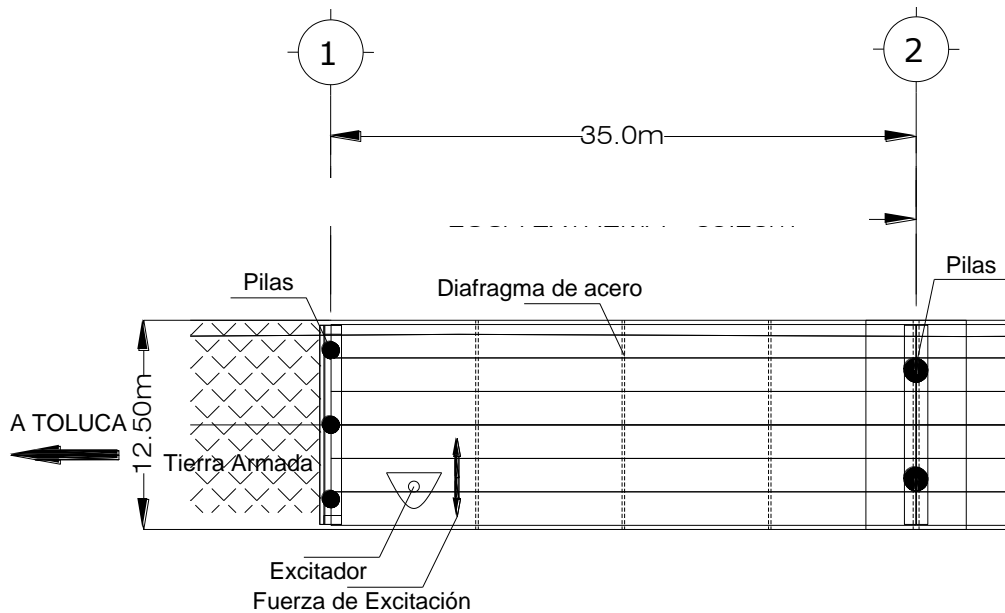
Vista en planta de la ubicación del excitador de masas excéntricas
